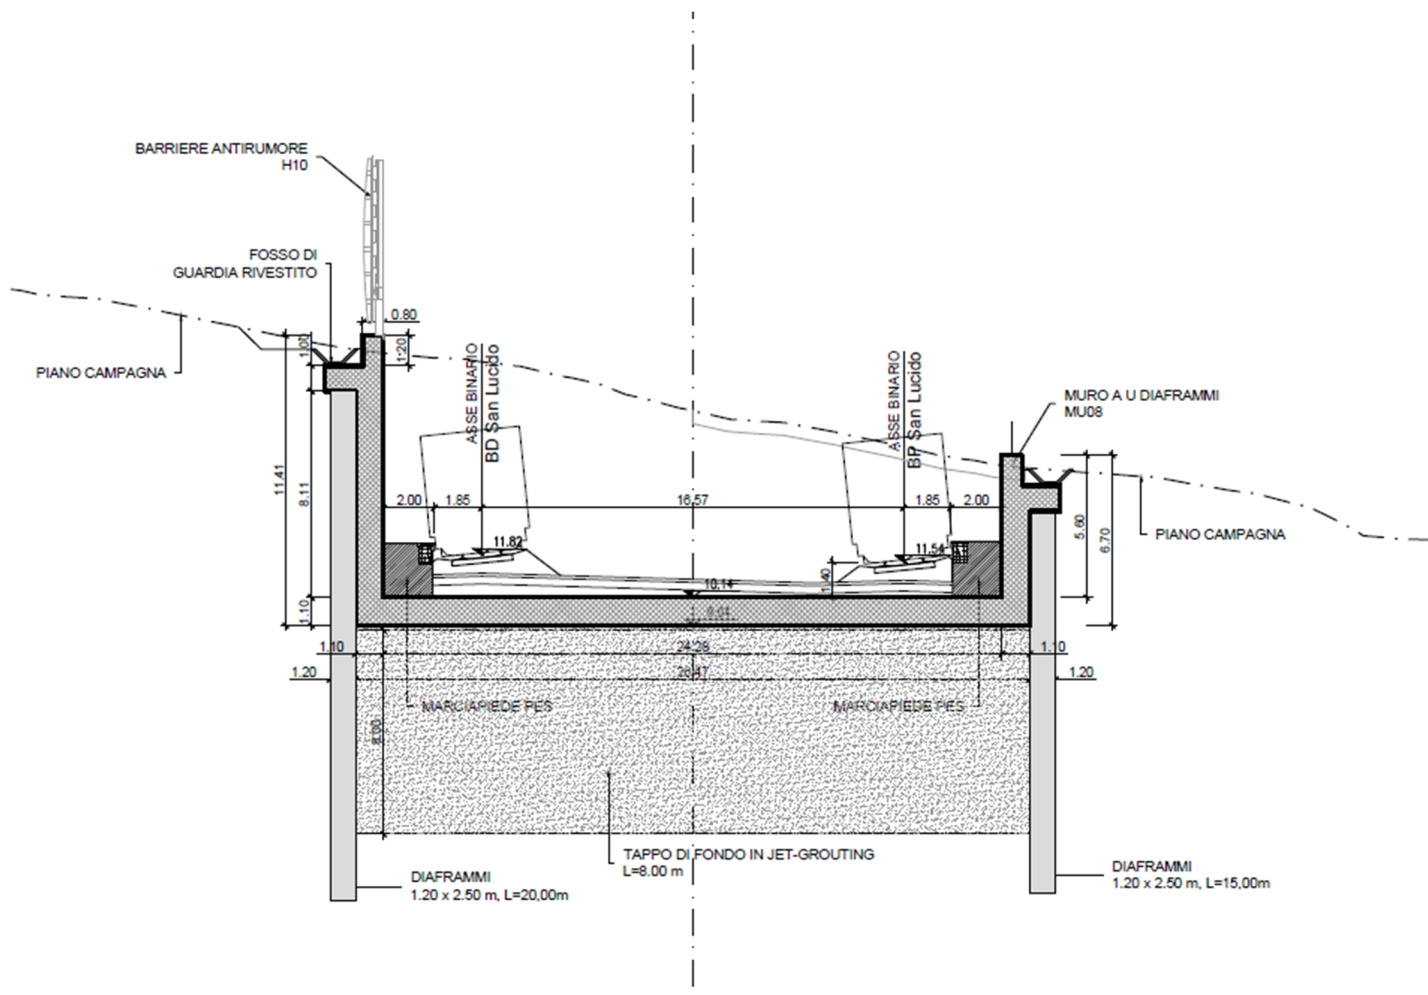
Sezioni Tipo Muro a U tra diaframmi Tipo2
